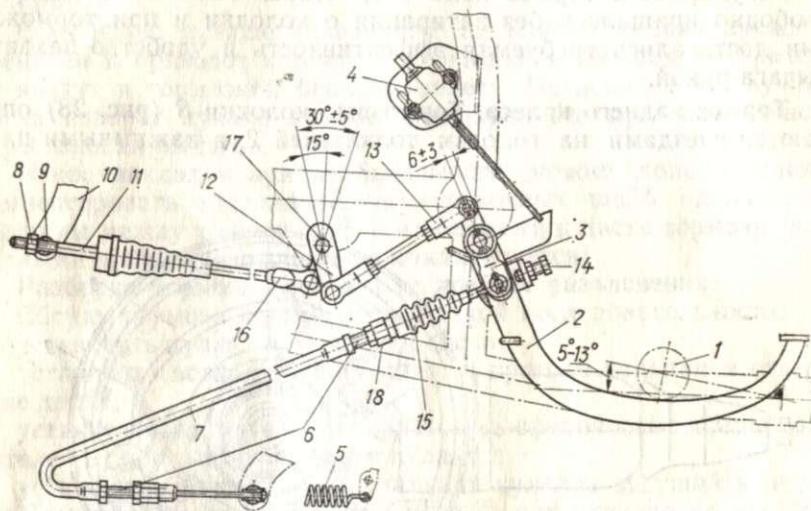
Привод тормоза заднего колеса и колеса бокового прицепа:
